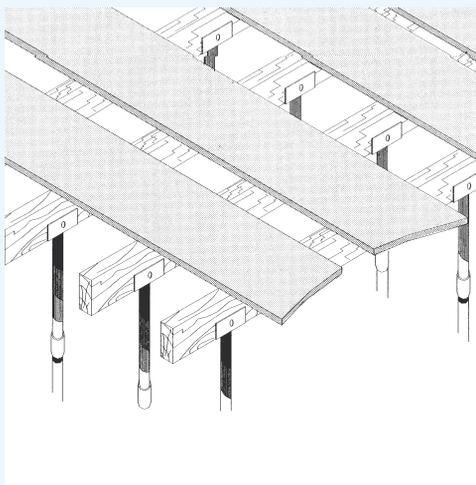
Pose et mise à niveau des planches ou bastaings
